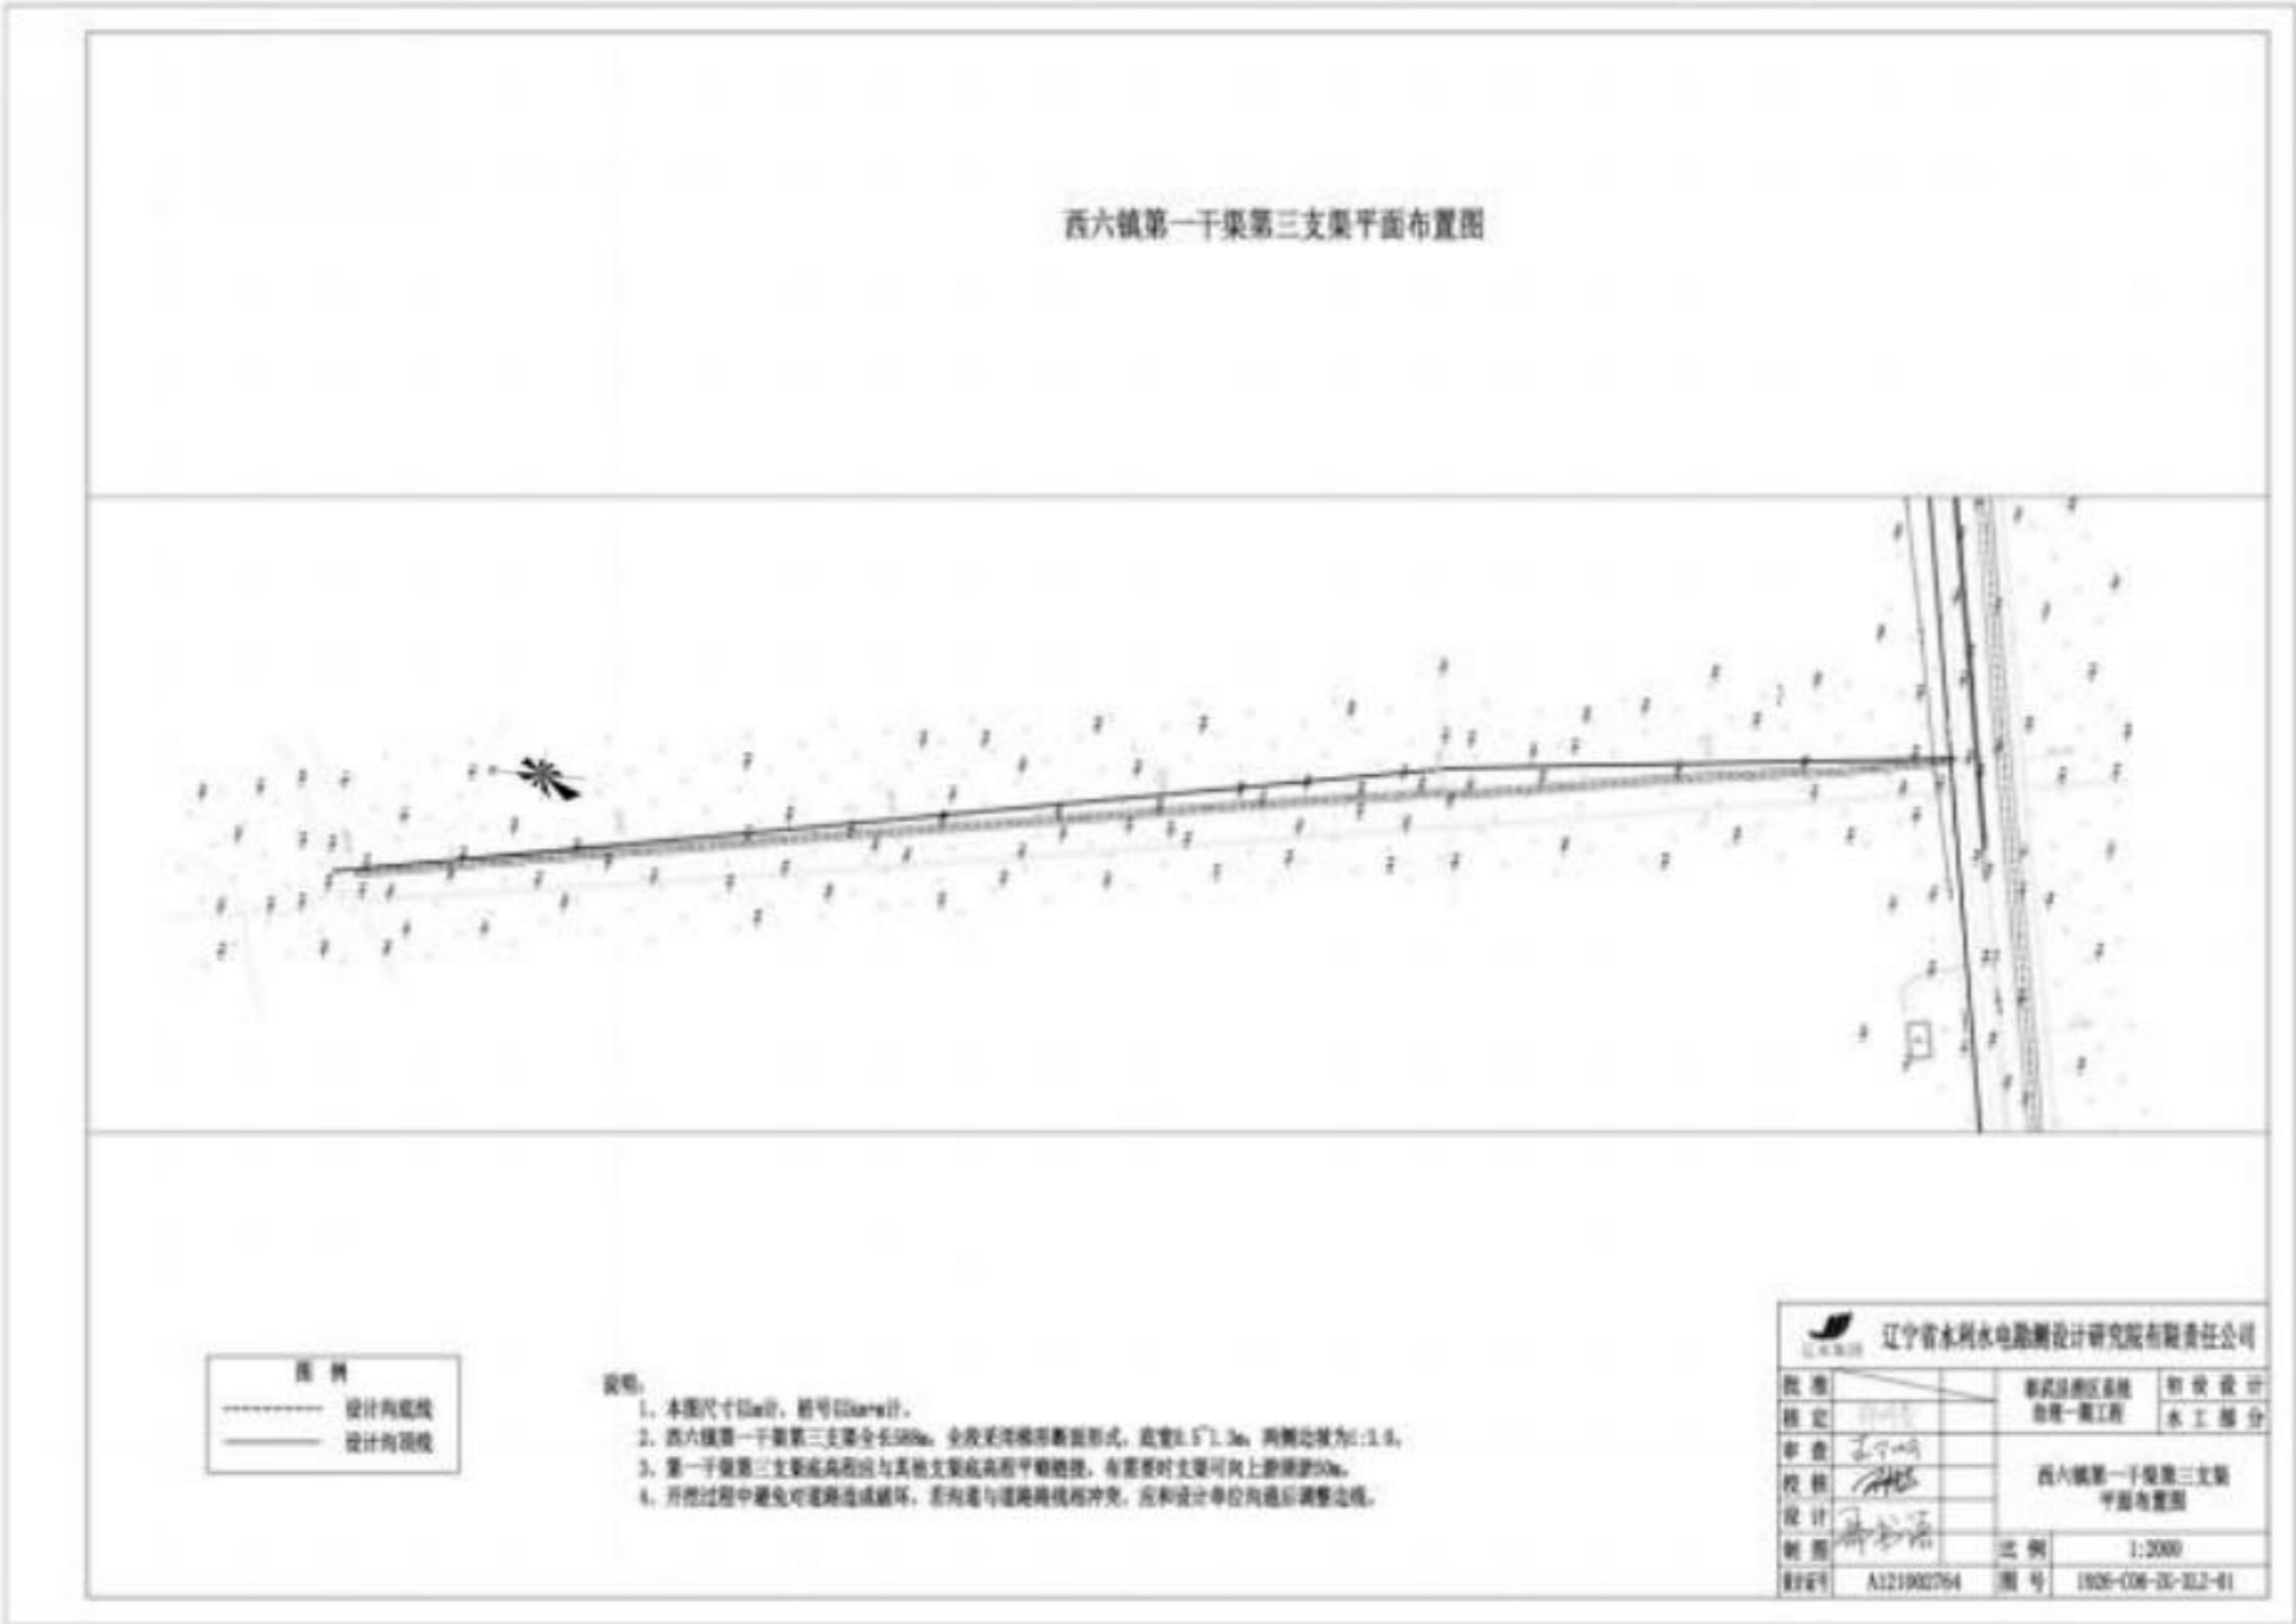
西六镇第一干渠第三支渠平面布置图
